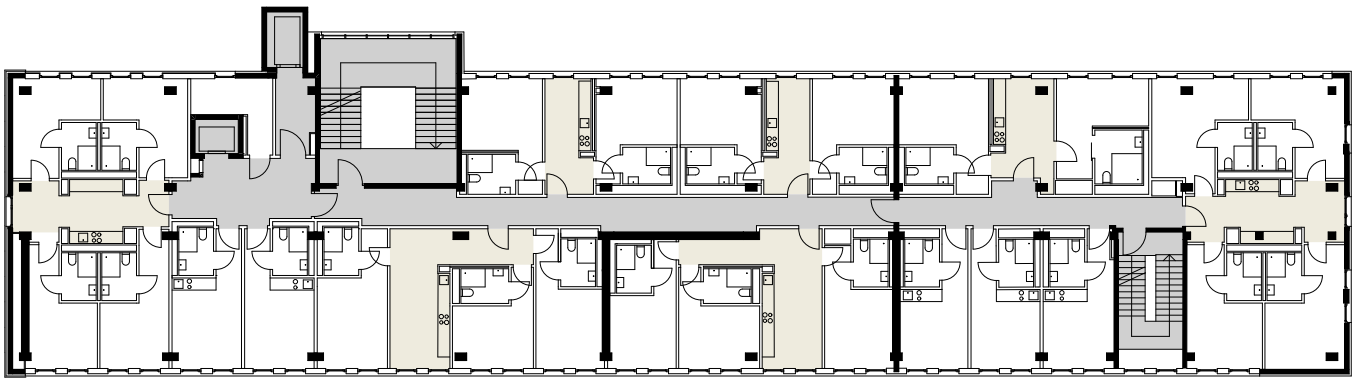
Grundriss Regelgeschoss mit unterschiedlichen Wohnangeboten, M. 1:375 [© BF Vario]
